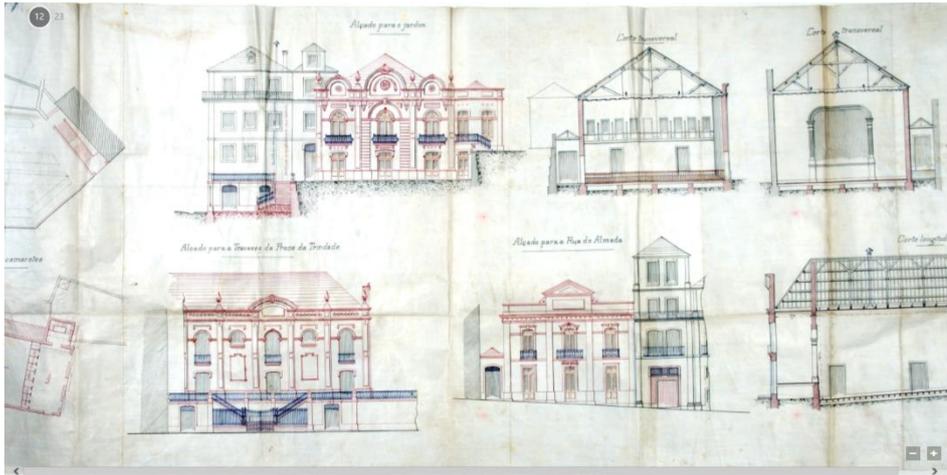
Projeto para as fachadas voltadas para o Jardim, Travessa da Praça da Trindade e Rua do Almada
